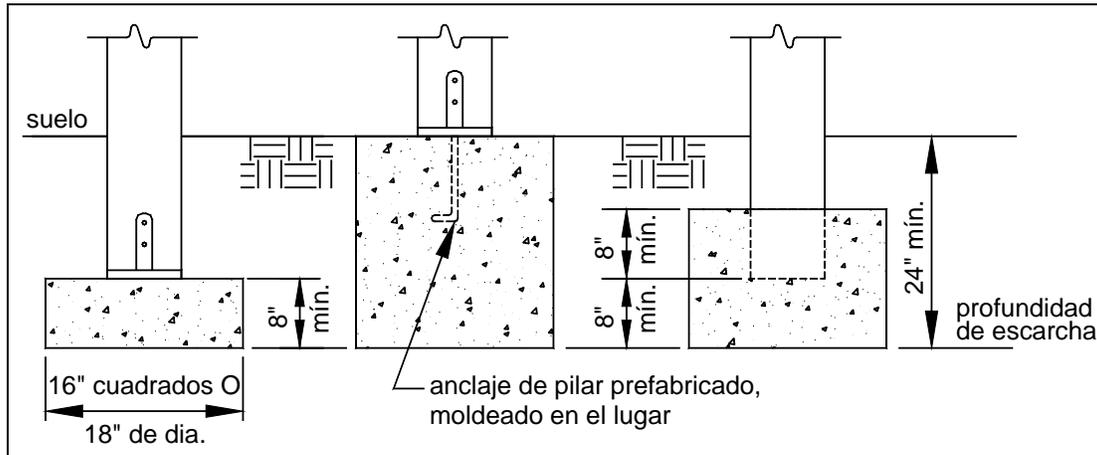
DETALLE DE APOYO DE LA CIMENTACIÓN TÍPICO
